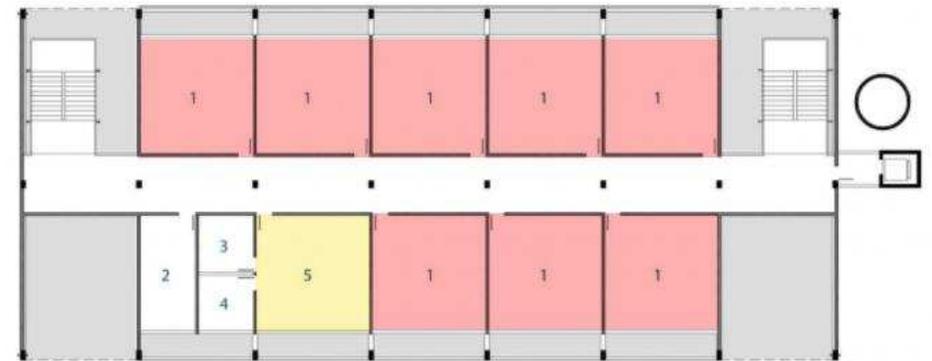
Escola em Campinas – planta do 1º pav. Fonte: Una Arquitetos, editado pela autora.
